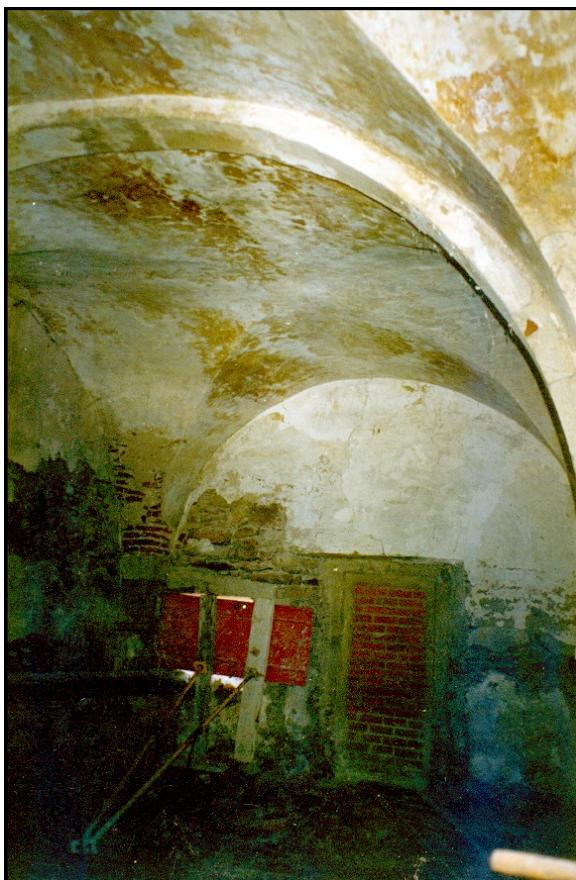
Detalle de una de las pinturas murales antes de su restauración.
